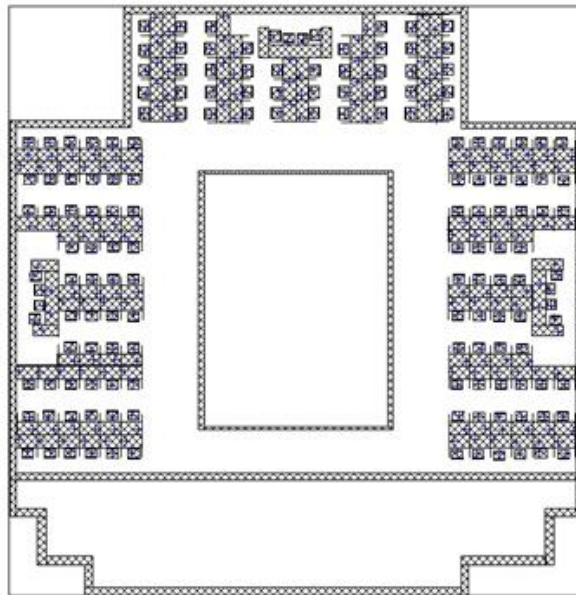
Muestra N°3. Planta e imágenes de los puestos de trabajo.
